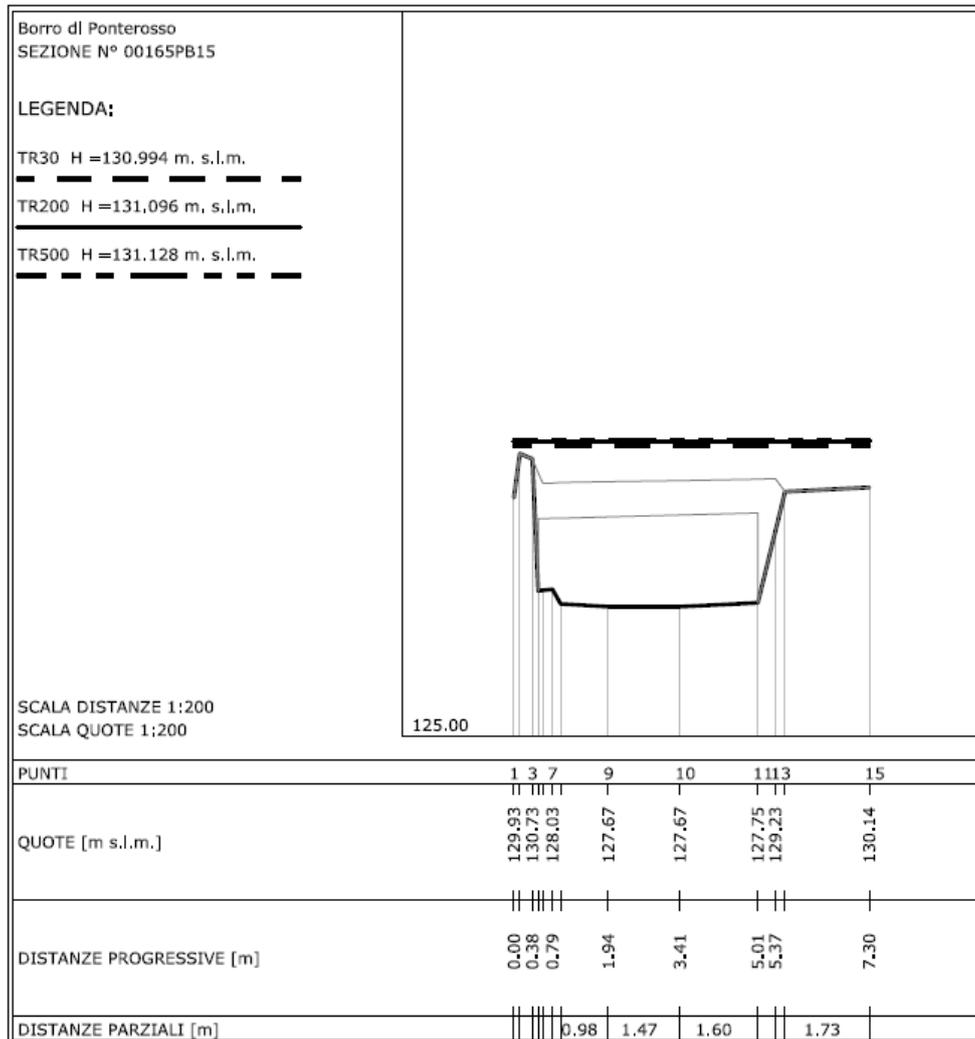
estratto di cartografia di Piano Strutturale “IS1.3_Libretto Sezioni Tr 30_200” – Sezione n. 00165PB15
